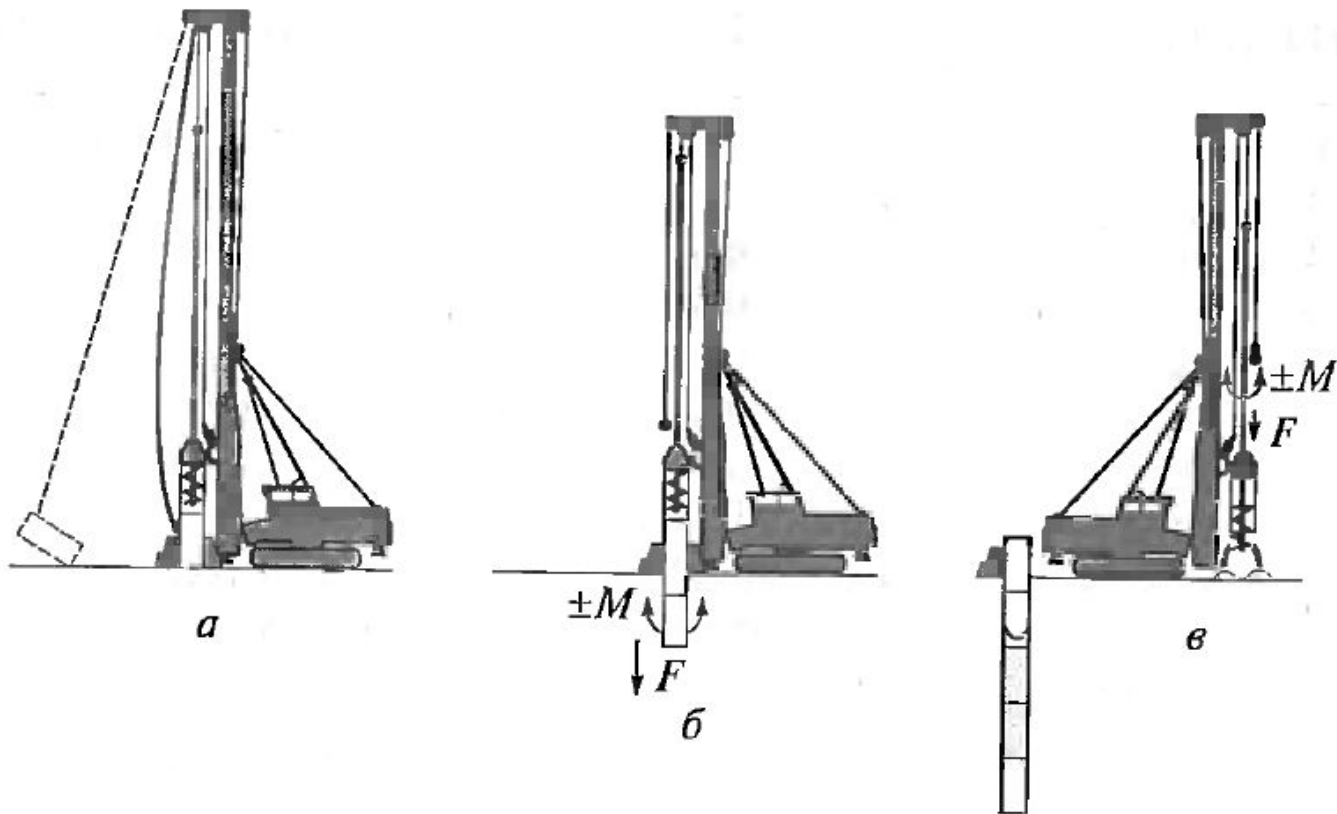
Технологическая схема устройства буронабивных свай в обсадной трубе с извлечением грунта:
